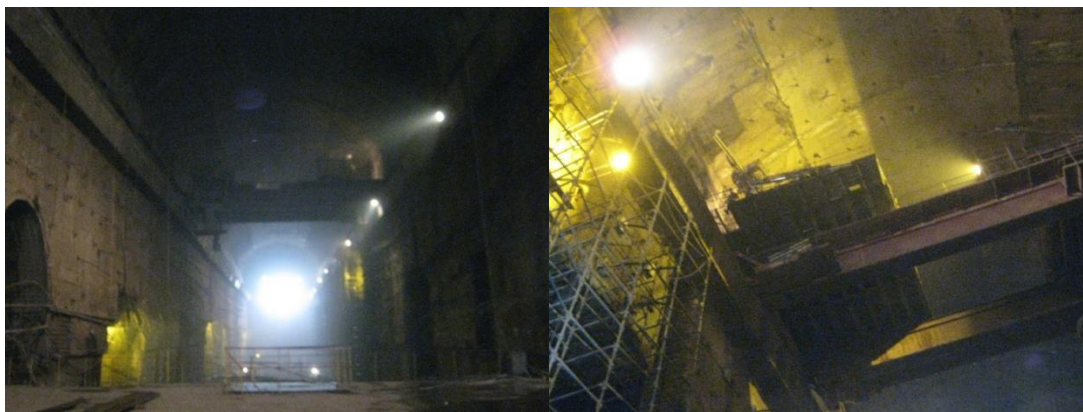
Слева выработка машинного зала: Вид со стороны монтажной площадки, справа – установленный мостовой кран
